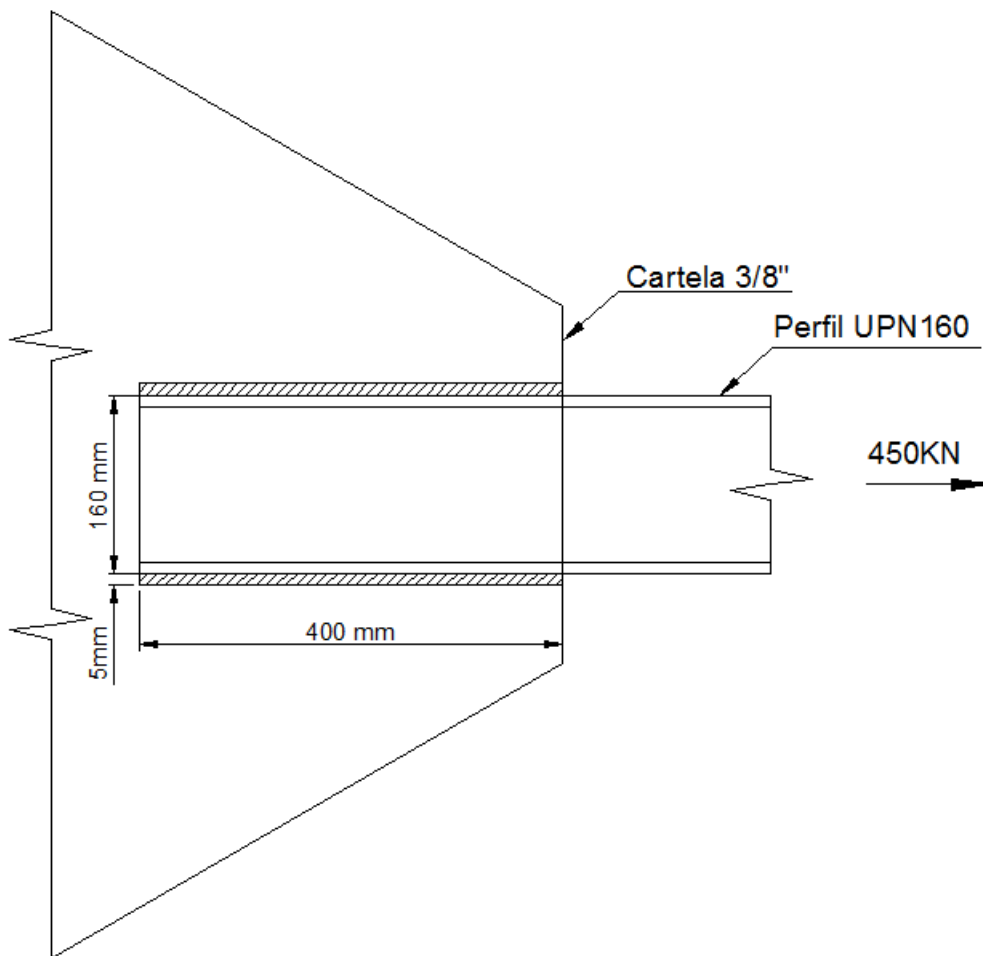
Unión soldada UPN160 con carga excéntrica
